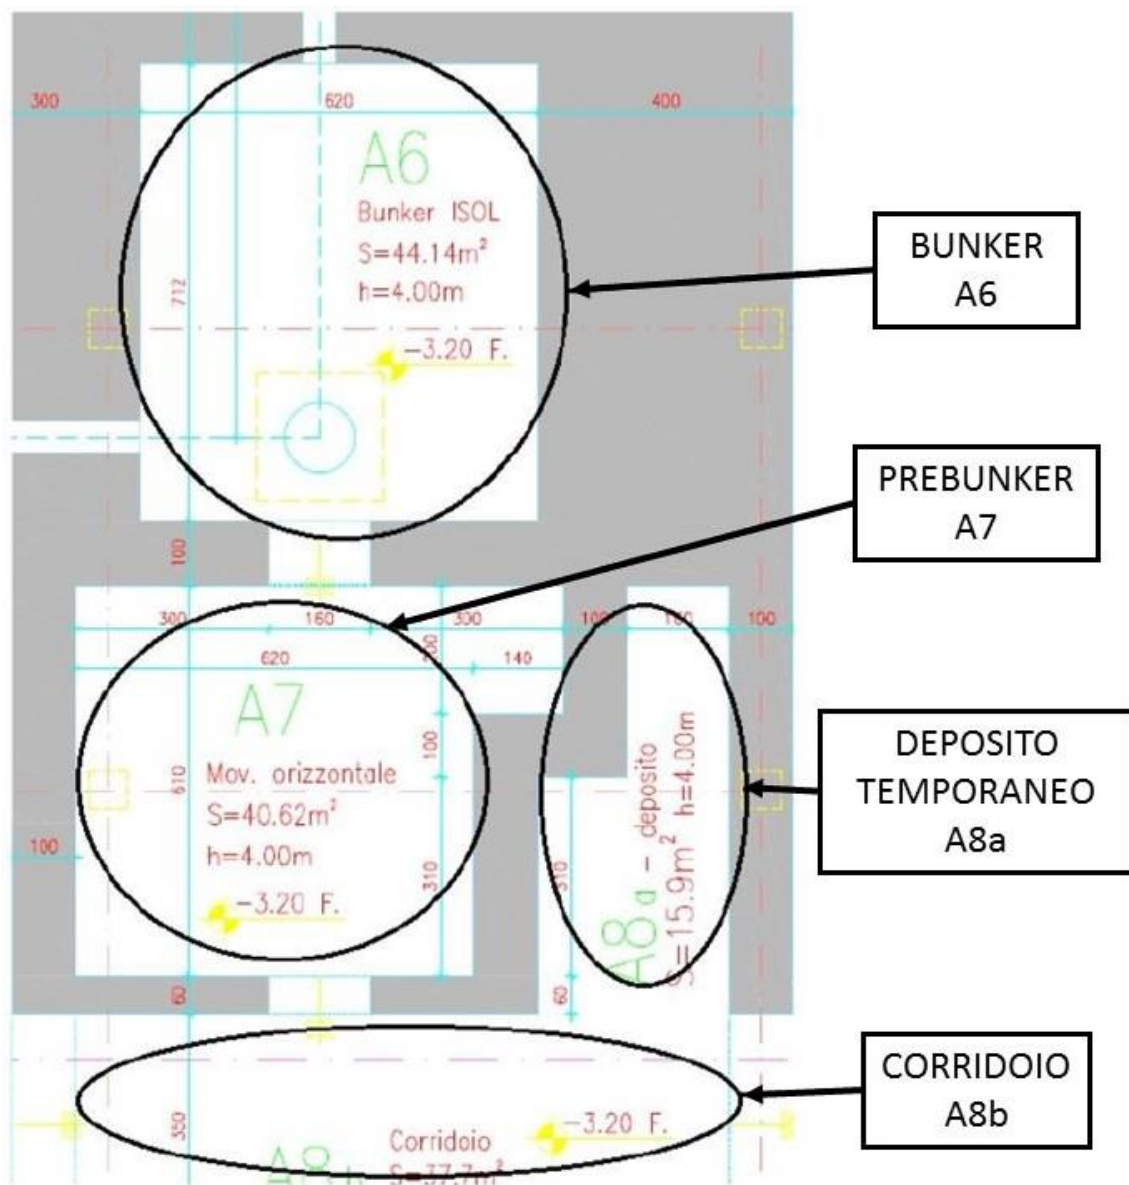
Pianta della zona di produzione e movimentazione.
